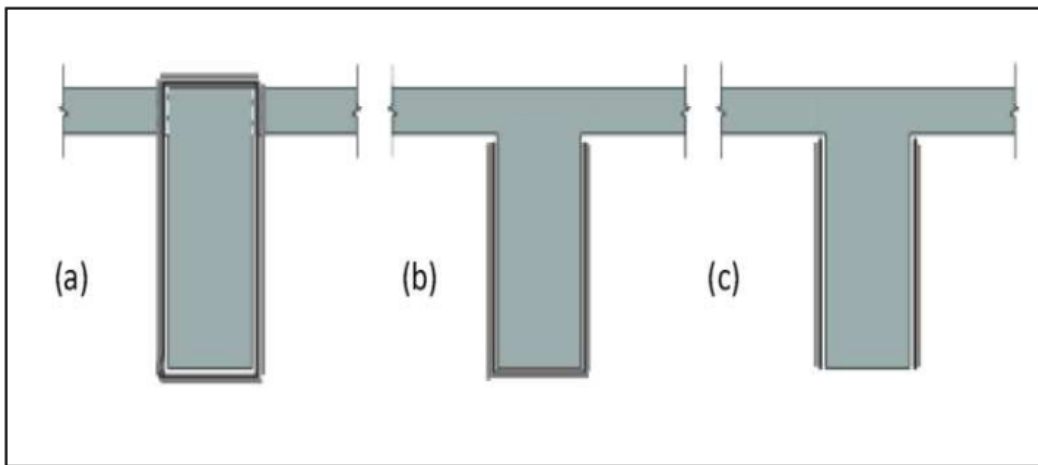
Technique de renforcement des poutres par collage de plaque en acier.
